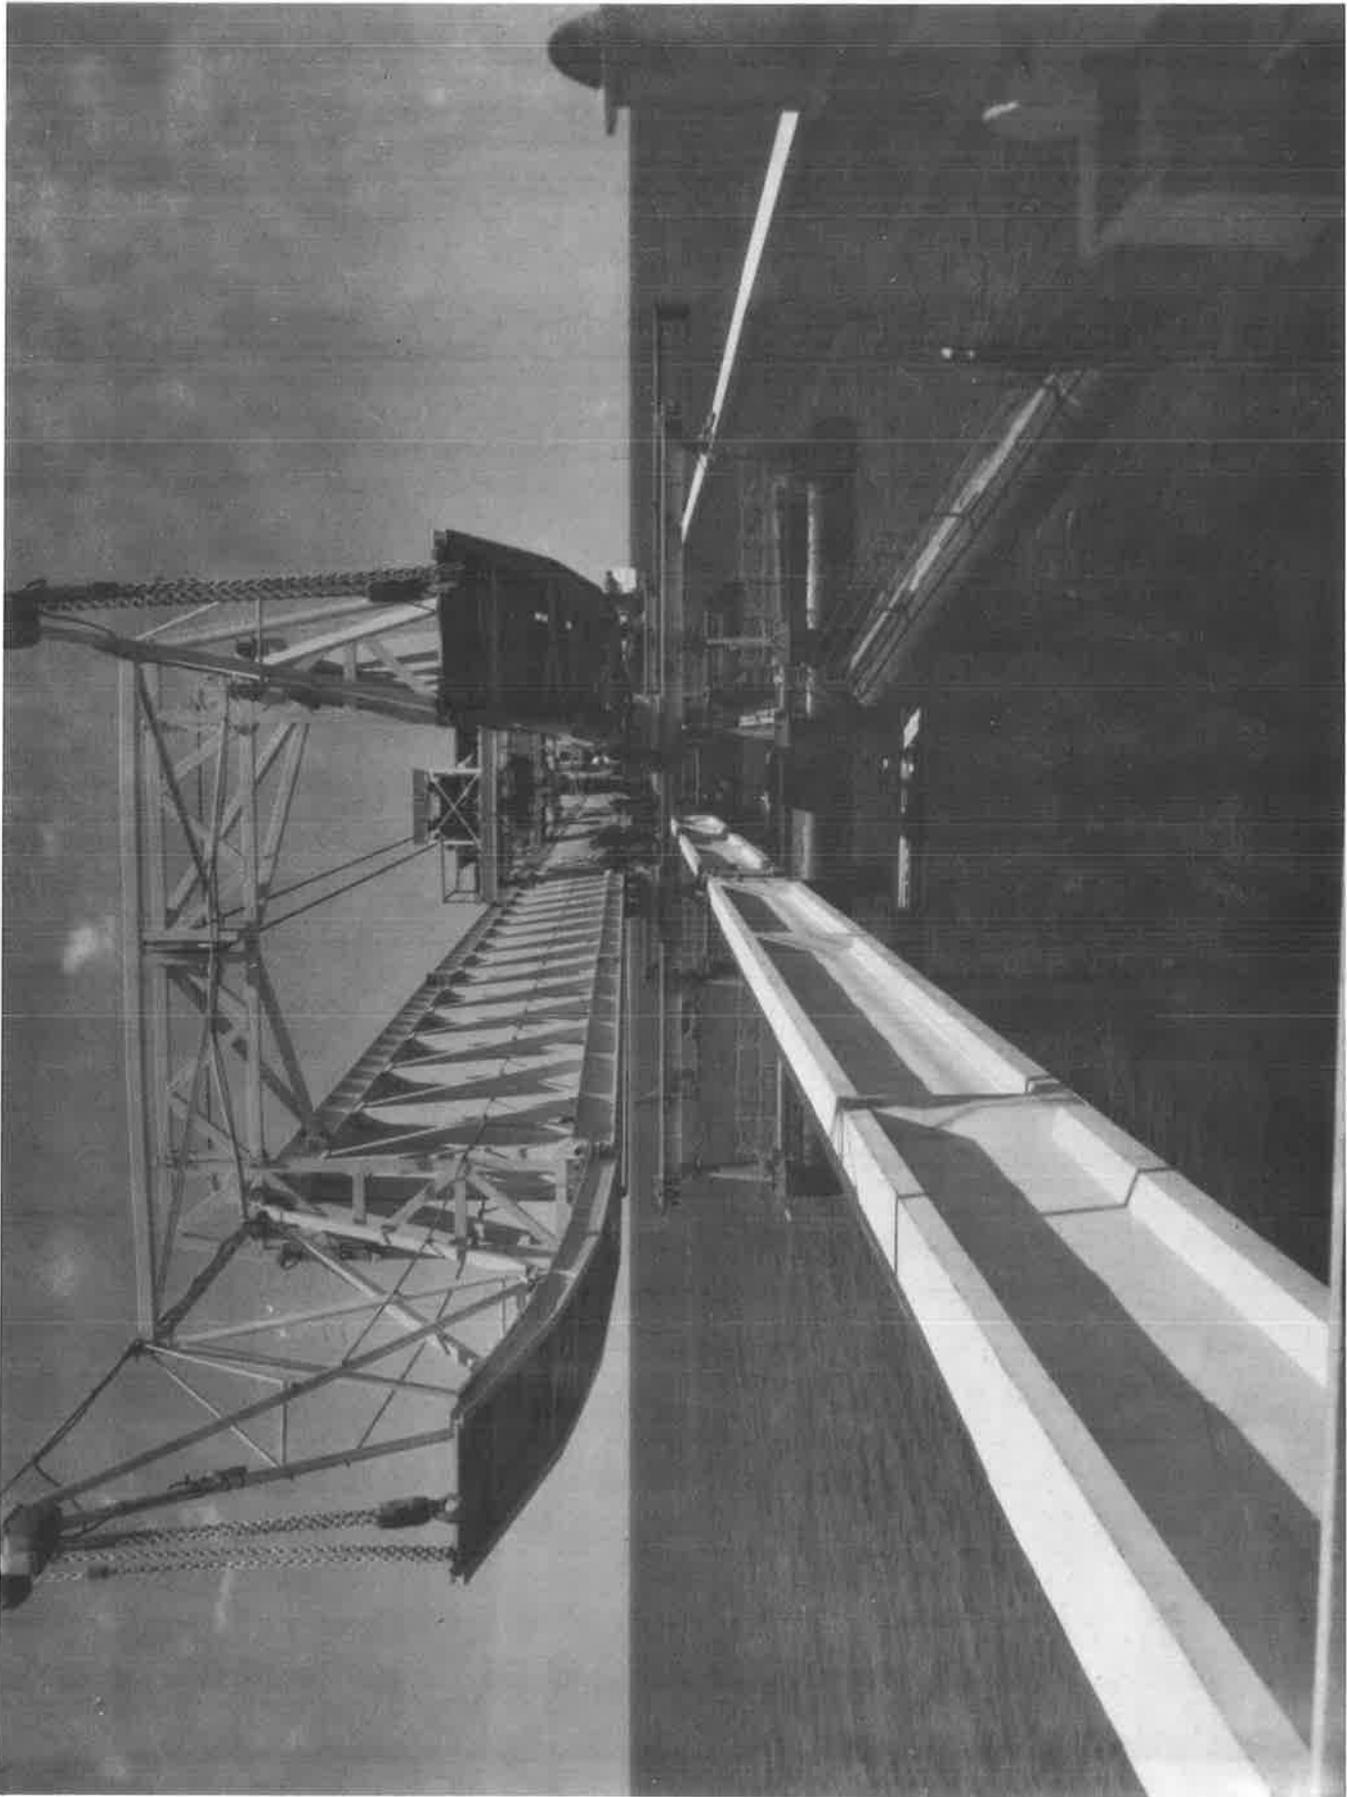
Pontile ISAB - Varo longitudinale delle travi pre-comprese del pontile
